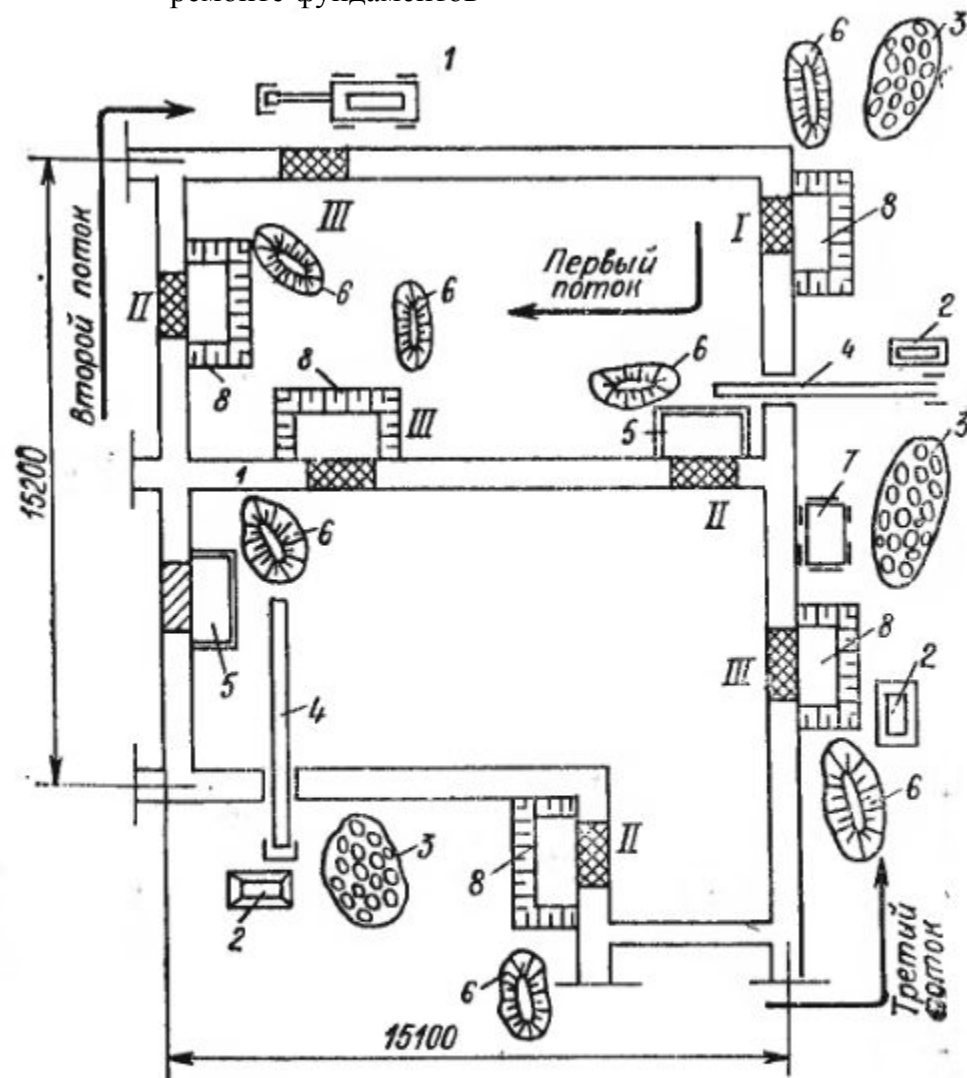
Схема организации работ по перекладке отдельных участков фундамента
